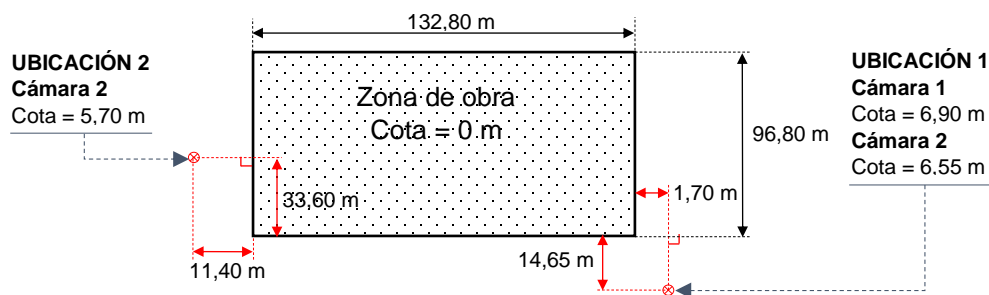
Esquema en planta de ubicación en obra de cámaras de video
